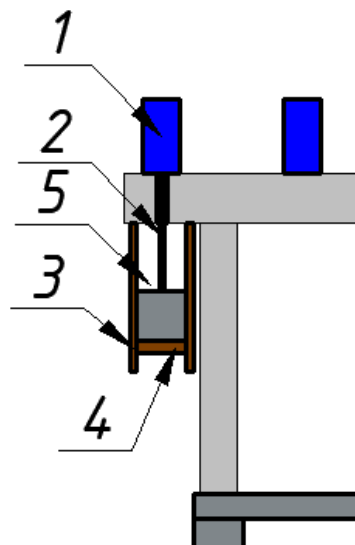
Опускание горизонтальной палубы с первым слоем бетона
